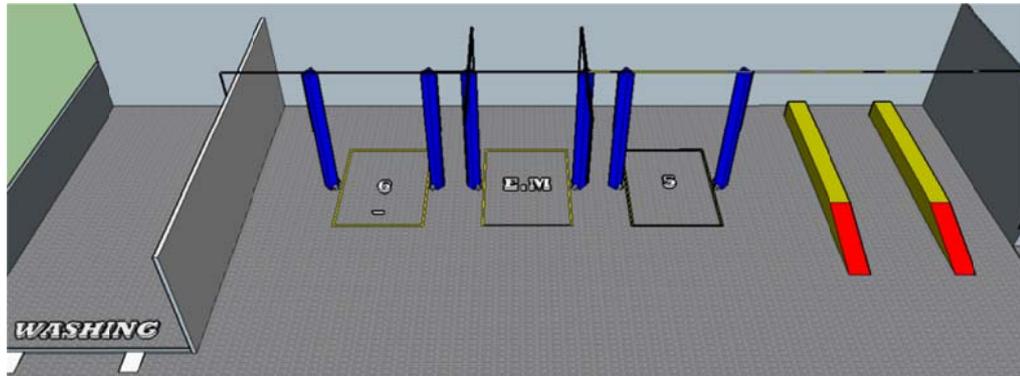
Rancangan jalur pipa tampak depan dan tampak sambungan pada pipa kerja
